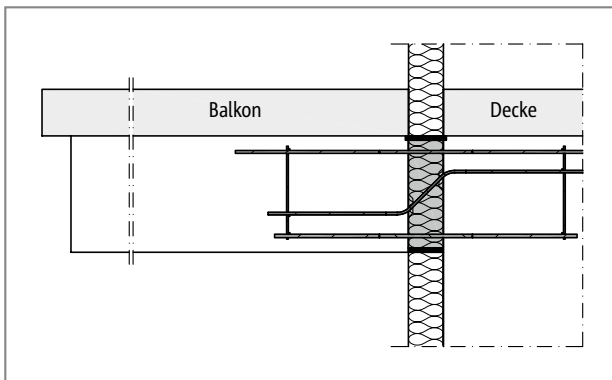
Schöck Isokorb® XT Typ BP: Balkonkonstruktion mit frei auskragenden Unterzügen (Fertigteilbalkon)
